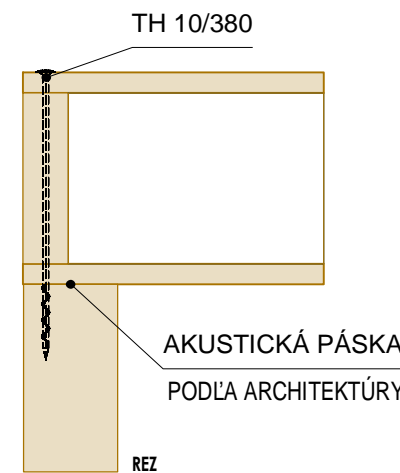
DETAIL "H" - PRIPOJENIE STROPNÉHO PANELU A BETÓNOVÉHO JADRA
